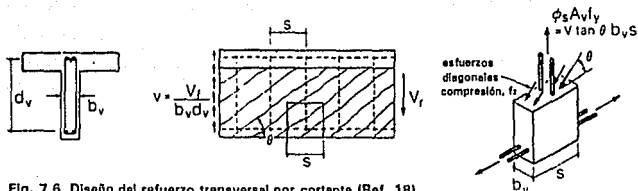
Diseño del refuerzo transversal por cortante (Ref. 18)
